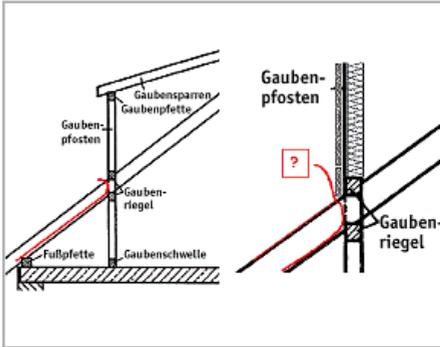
und 229: Indachdämmung zwischen Dachsparren mit eingeschlaufener Sperrfolie
